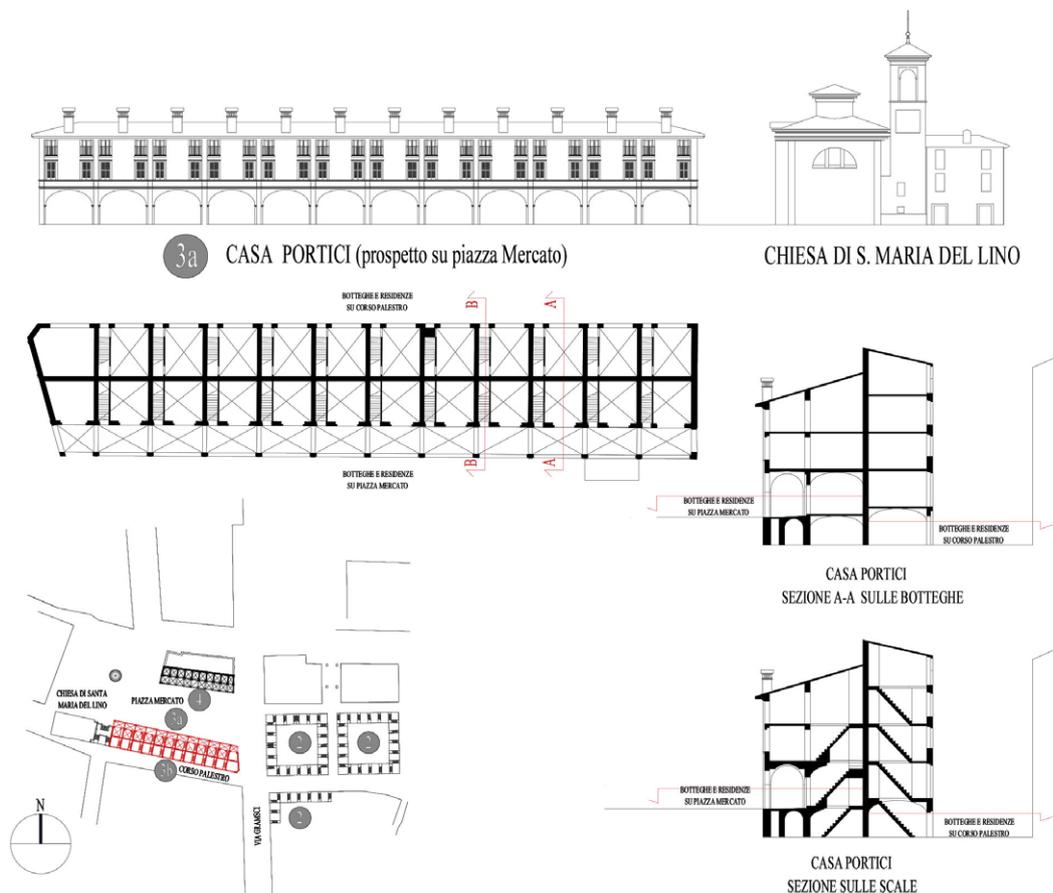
Brescia, piazza Mercato. Prospetto, pianta e sezioni della Casa Portici. Elaborazione degli autori.
